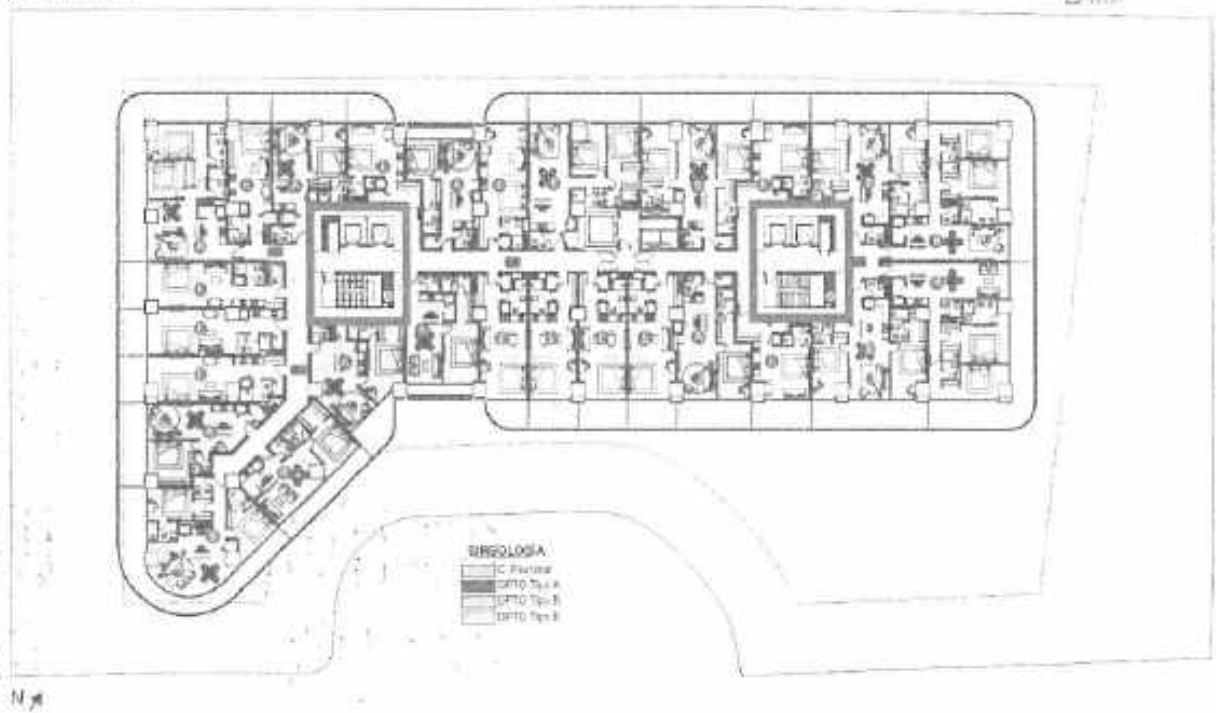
Circulaciones Verticales en Planta Tipo Apartamentos
